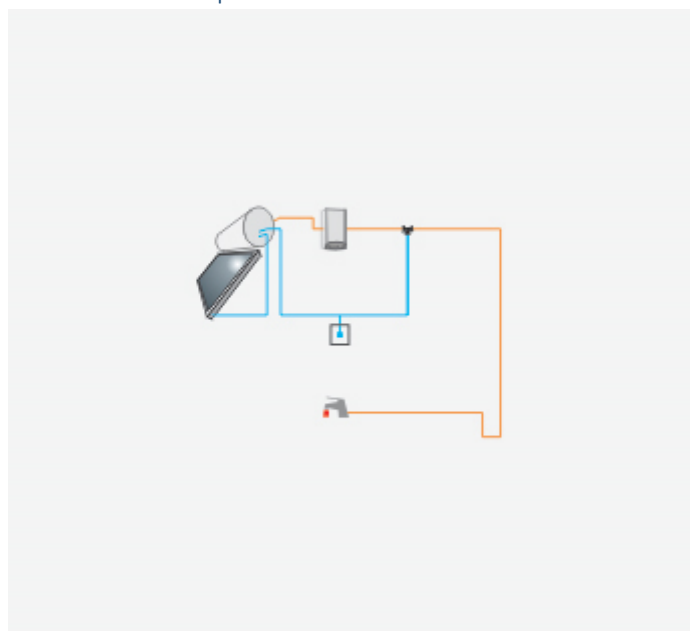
Esquema de la instalación con sistema prefabricado [CHEQ4]
